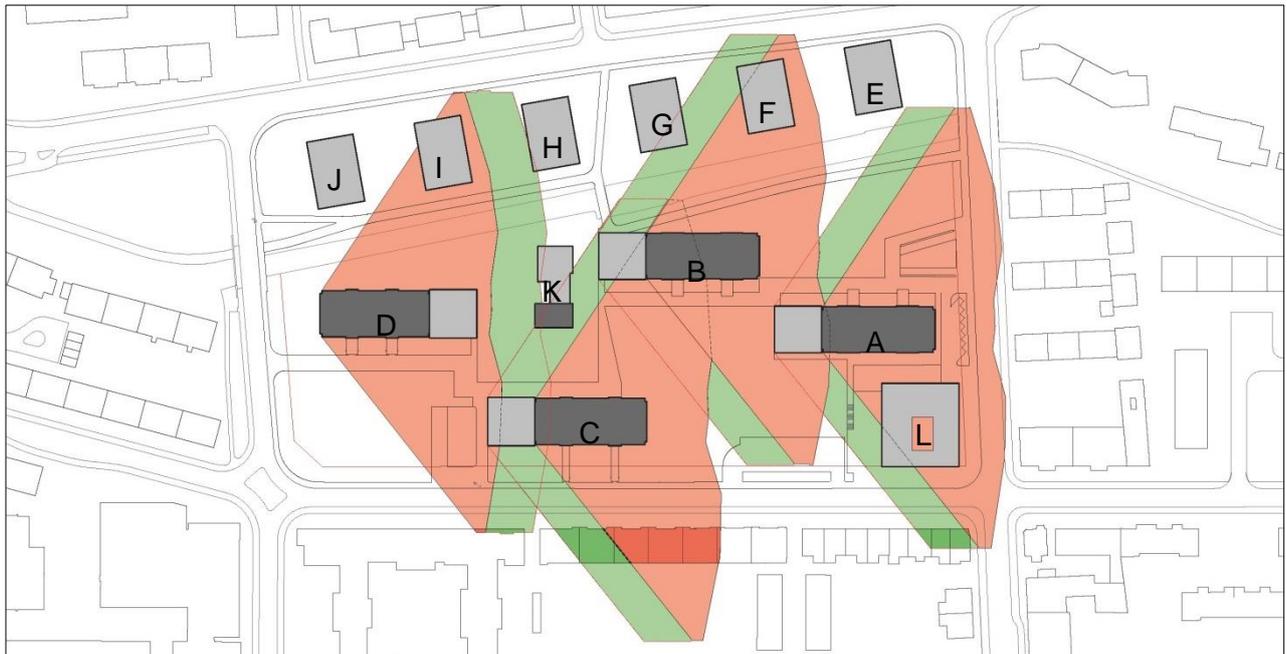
Situation Areal Albanteich-Promenade: 2 Stunden-Schatten der bestehenden Gebäude (rot) und der Anbauten (grün). Quelle: Morger + Dettli, 2014 (kein Massstab, Plan nicht genordet)
